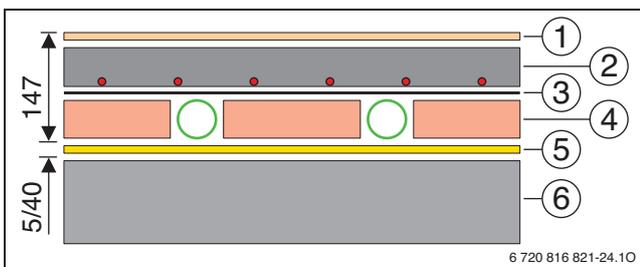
Canale tondo su soffitto in cemento grezzo (misure in mm)
